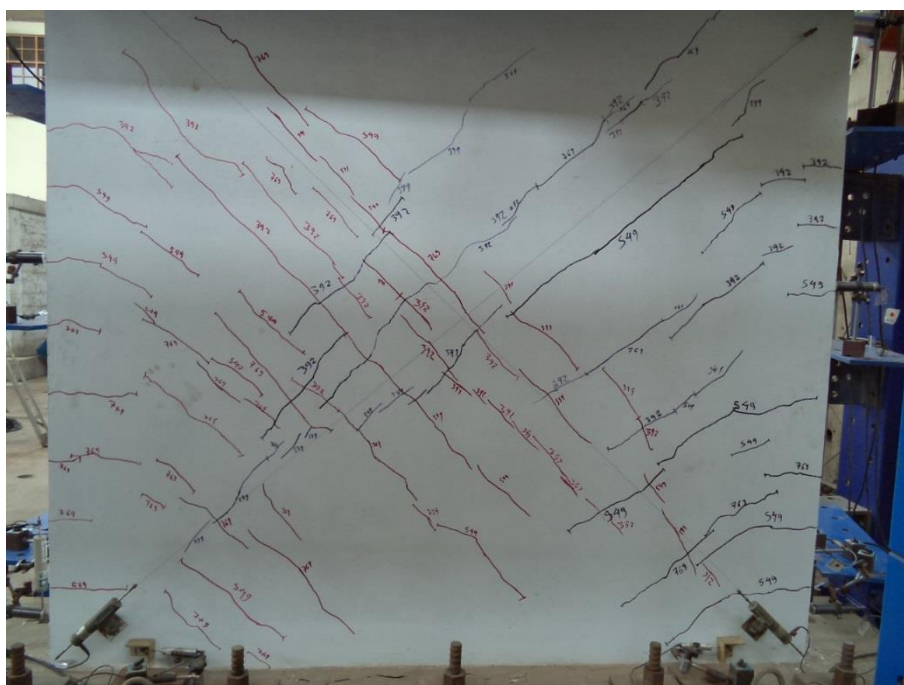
Grietas dietas diagonales en la cara del muro
